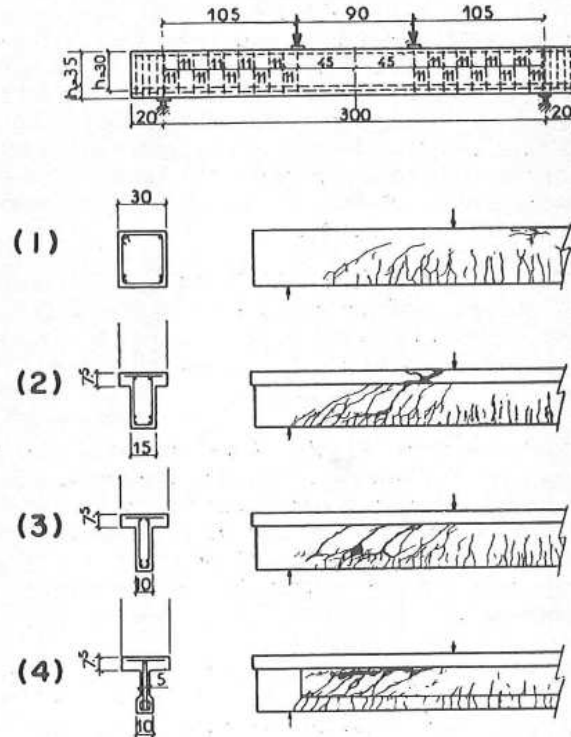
Ensayos en secciones en T (Leonhardt)
